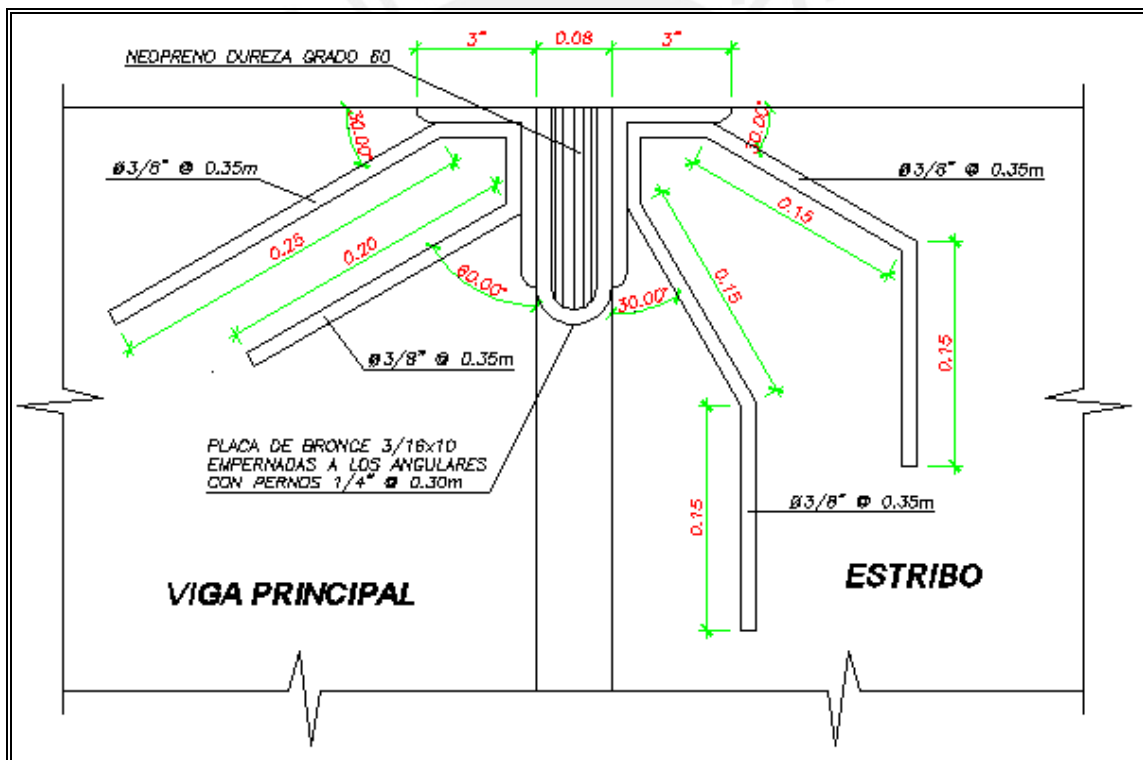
Configuración recomendada en Junta Sísmica entre viga y estribo.
